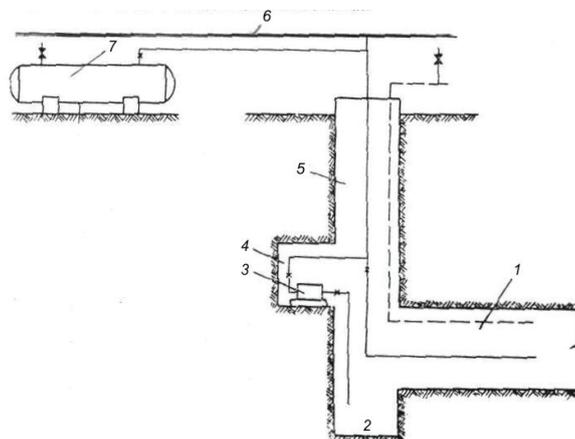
Схема подземного шахтного хранилища нефти:
